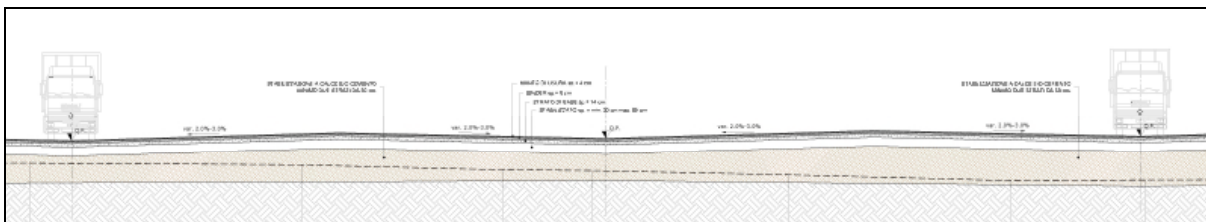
Stralcio Sezione Piazzale di Sosta
